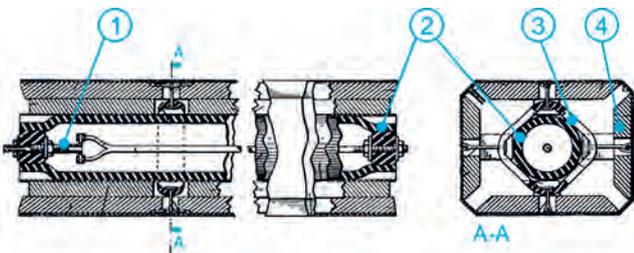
Продольный и поперечный разрез с изображением активной зоны в развернутом положении [11]; (1) трубка подачи воздуха, (2) резиновый конус, (3) ленты для удержания резинового сердечника, (4) профиль для установки сердечника
